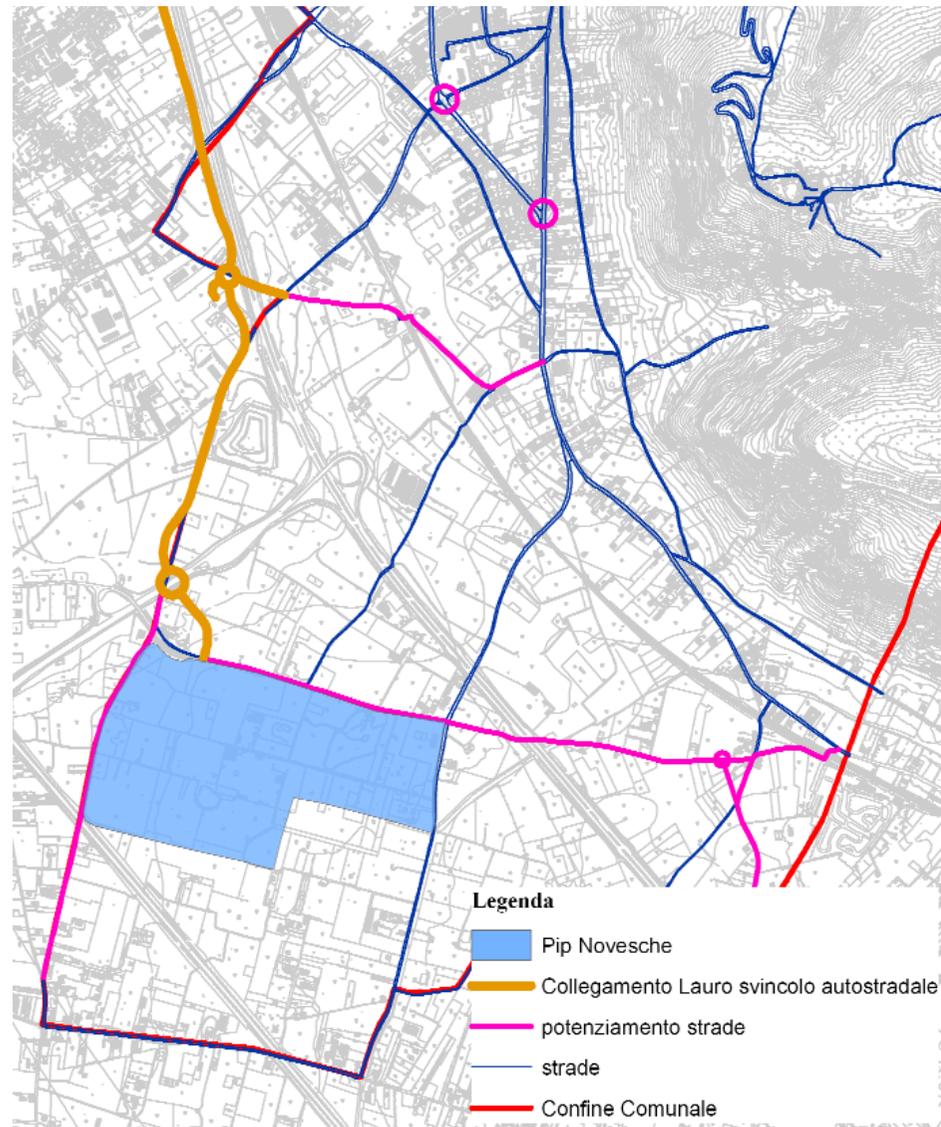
Planimetria della proposta di intervento per la viabilità dell'area interessata per la realizzazione della stazione di interscambio Av nel Comune di Striano
